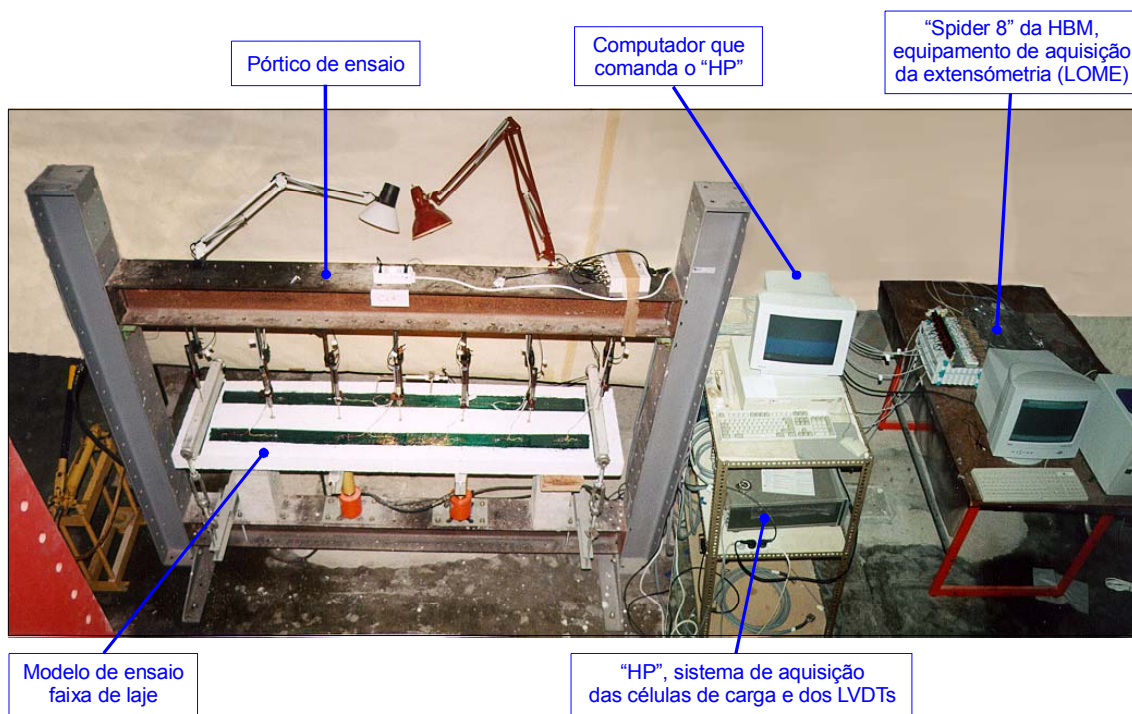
Aspecto geral da instrumentação do ensaio de flexão de uma laje.
